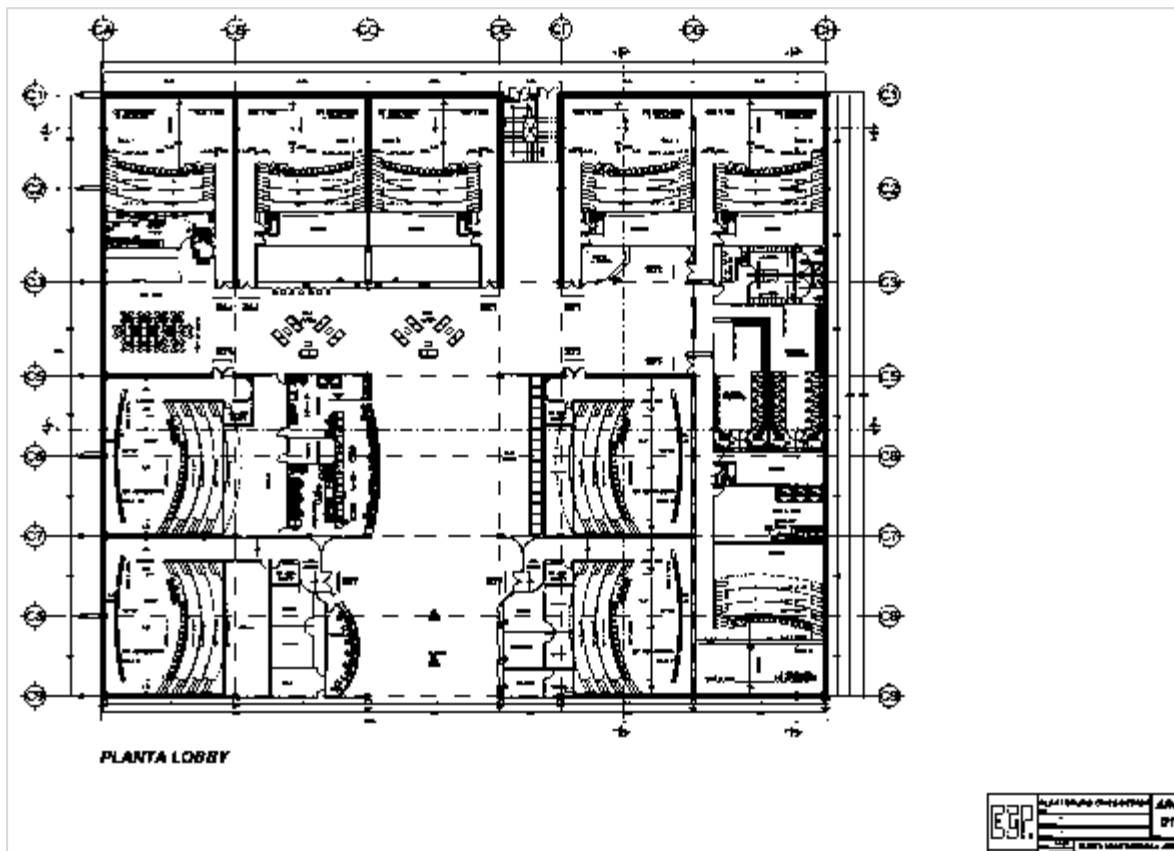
Plano Arquitectónico de Cines Hollywood, Macroplaza, Mérida, Yucatán
